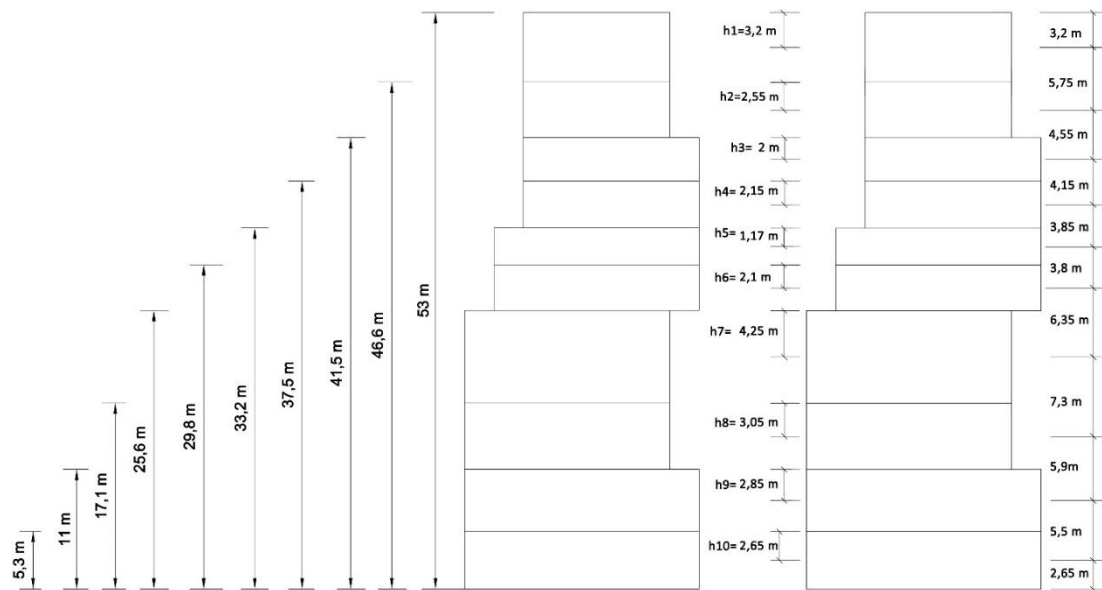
Alzado oeste del edificio, con las alturas de cada planta. Elaboración propia.
